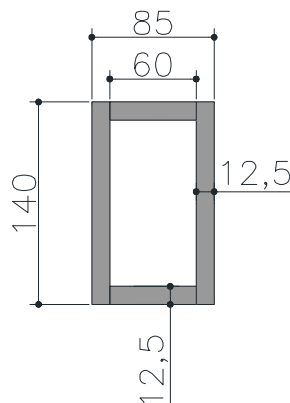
Dimensões do perfil utilizado como dente metálico.
